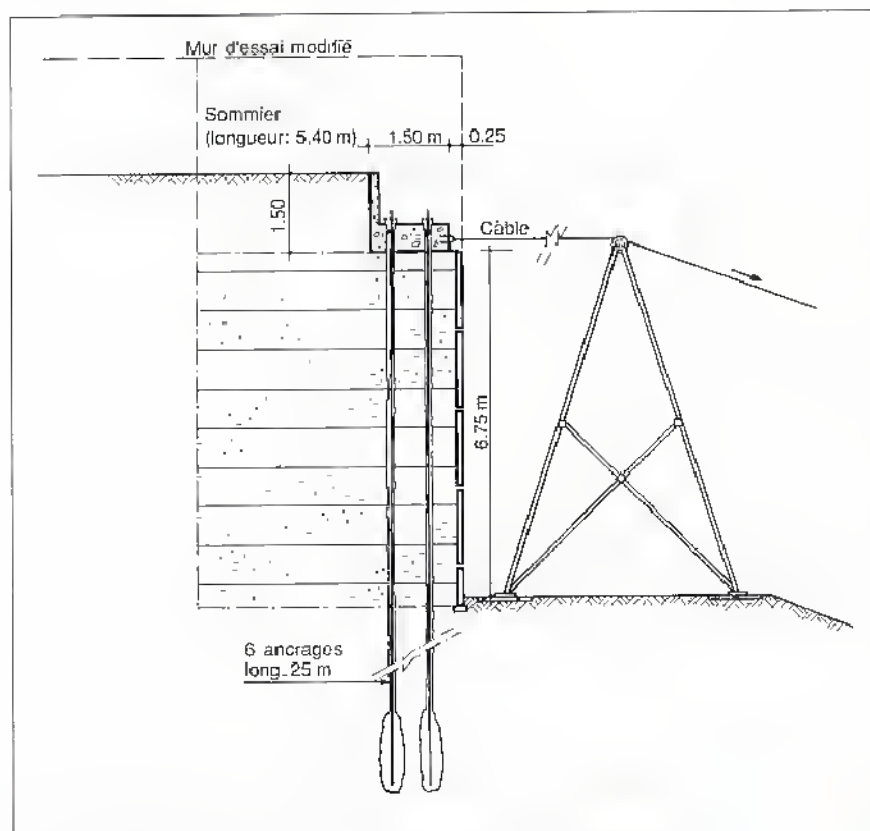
Application des surcharges sur le mur expérimental de Fontainebleau.
